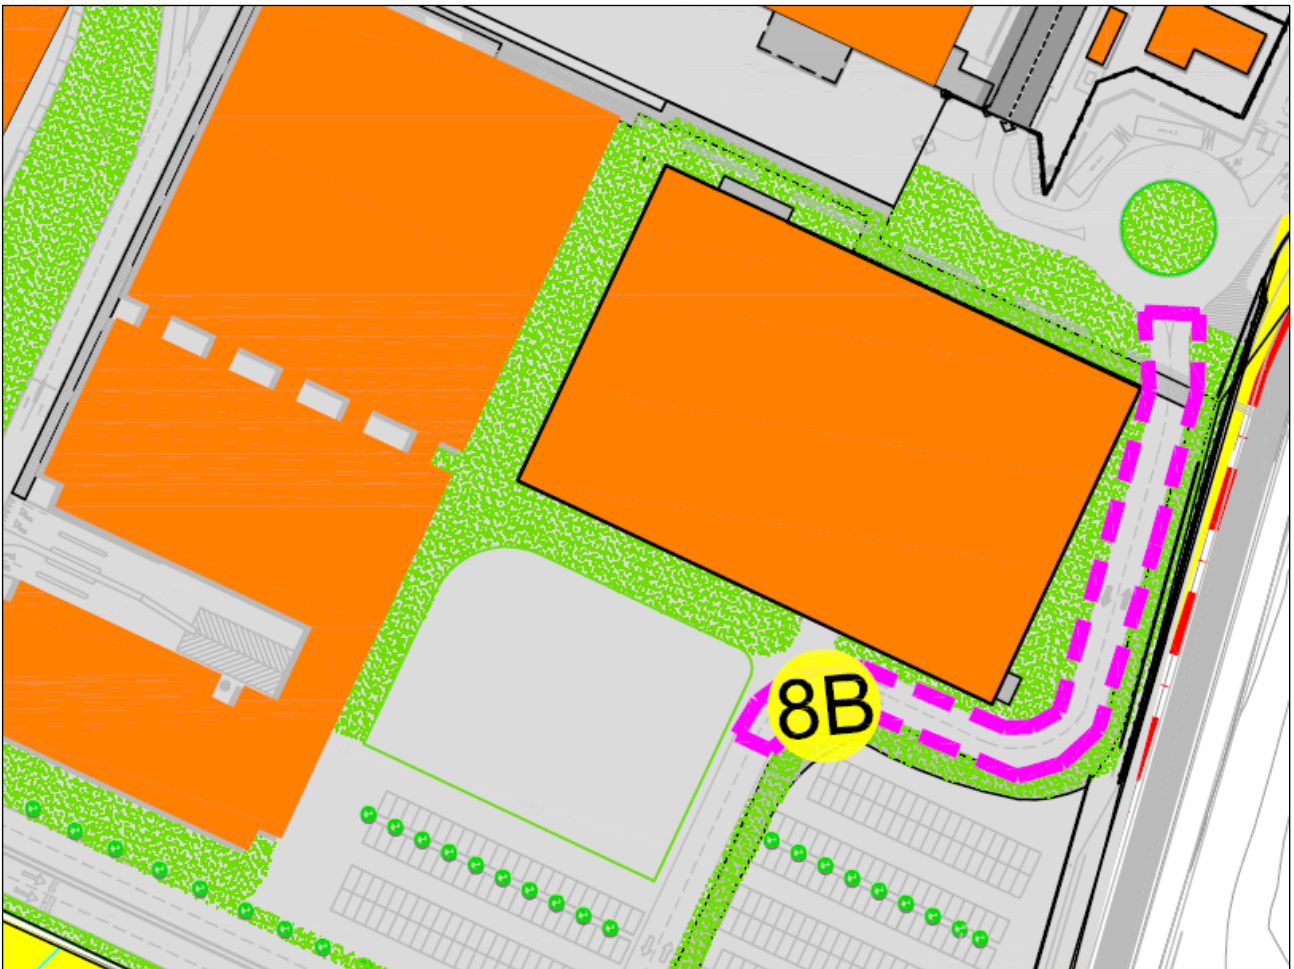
Estratto Master Plan – Intervento realizzazione della Nuova Viabilità per il Parcheggio Staff
